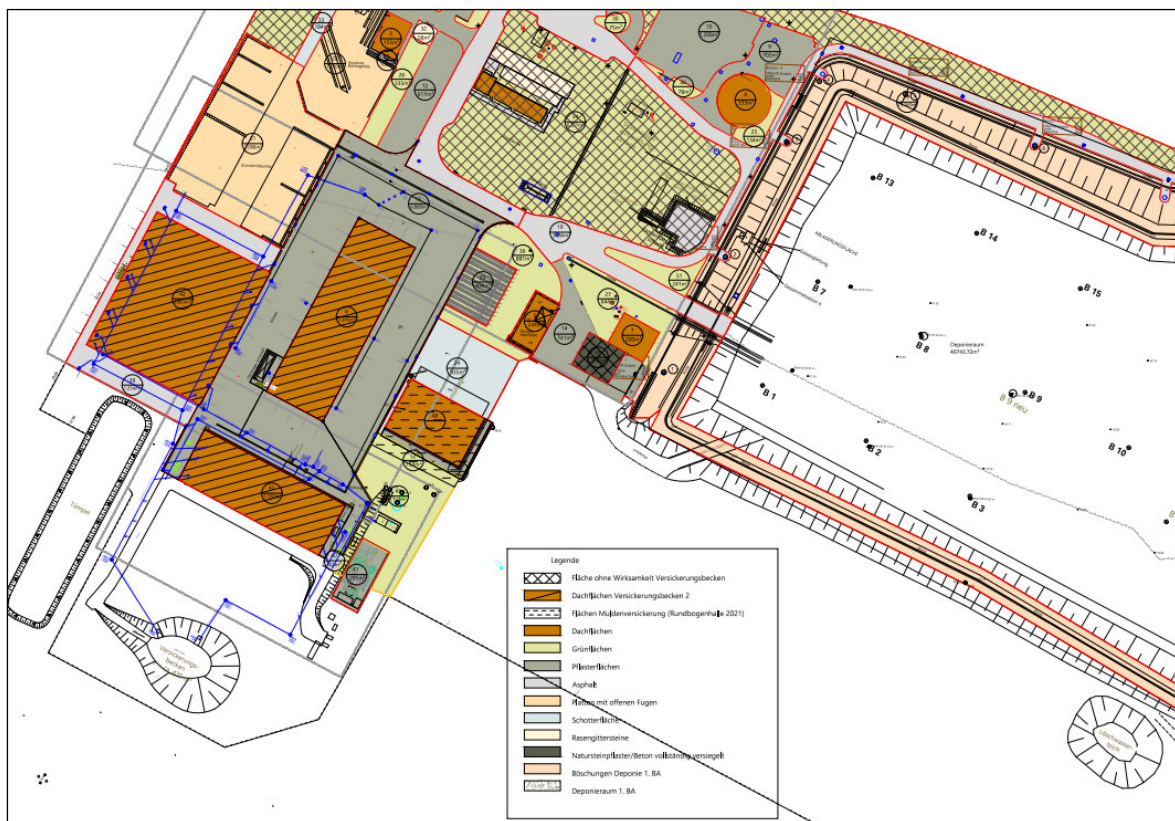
Darstellung der Einzugsflächen außerhalb des Deponiekörpers (Quelle: Bestandslageplan 3182GP030 [83])
